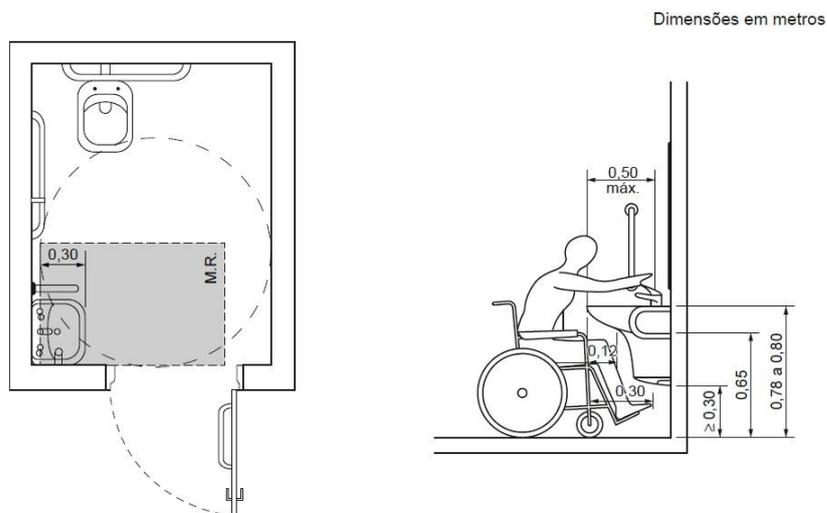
Instalação de lavatório em boxe acessível (planta e elevação)
